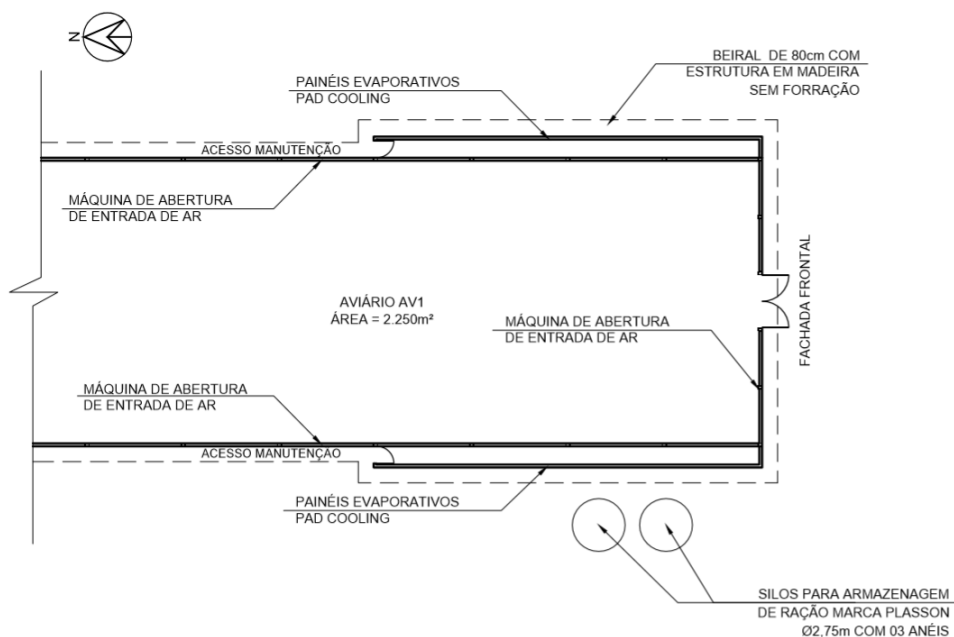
Planta baixa com a localização do sistema de resfriamento pad cooling.
